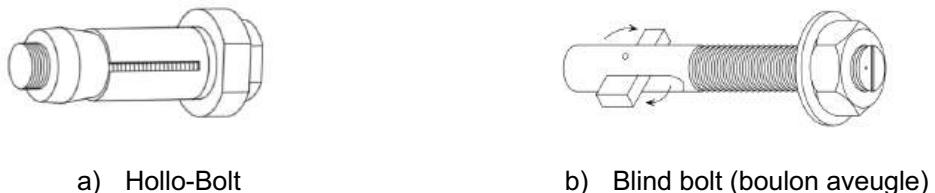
Solutions Hollo-Bolt et Bild Bolt [32]
